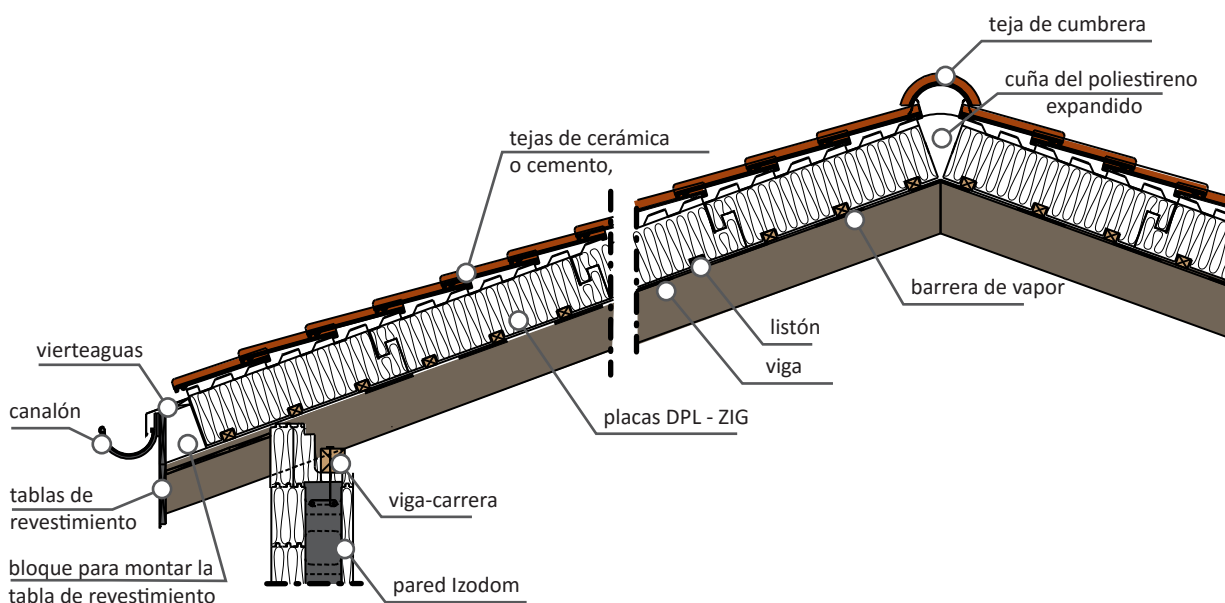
Imagen C. Sección vertical que ilustra un variante de la cubierta del techo con teja plana.
